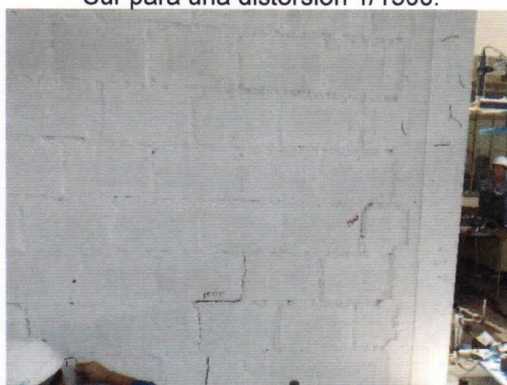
Formación de pequeñas grietas diagonales en el mortero en la parte inferior Este de la cara Sur para una distorsión 1/1500.
